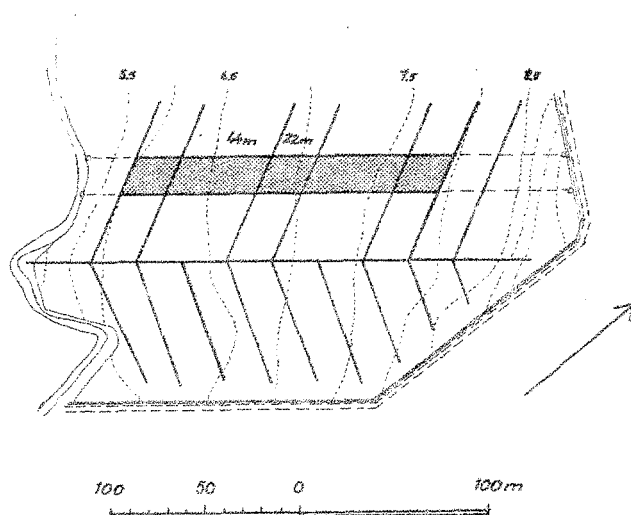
1. Ängsstugan, Stockholms län. Plan över dräneringsförsök med dikesavstånden 22 och 44 m.
